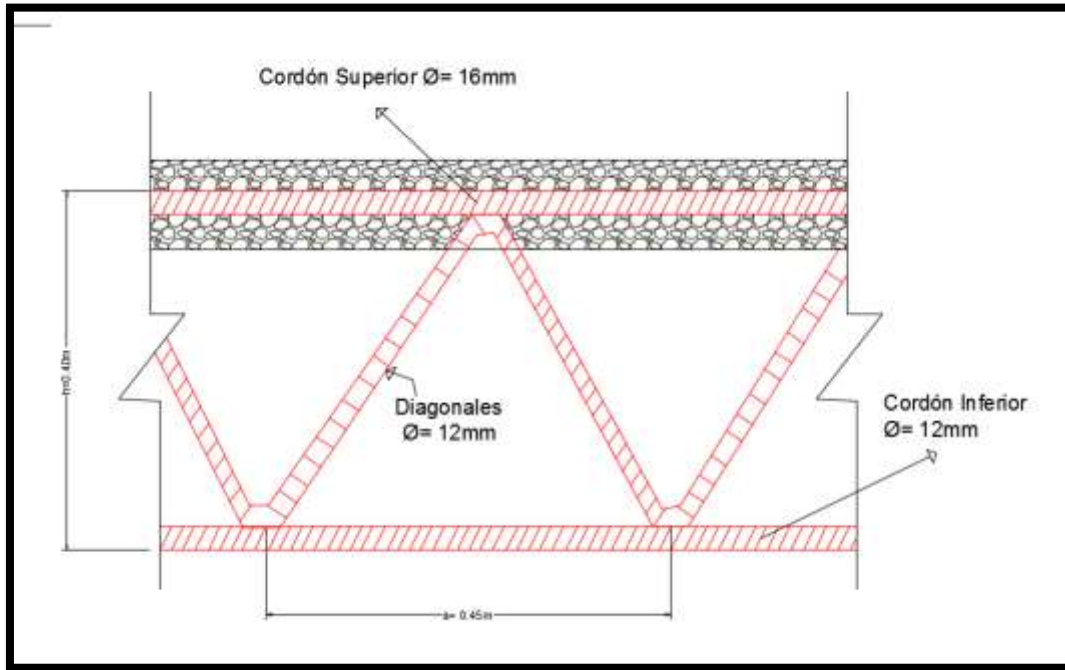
Detalle de una Sección de losa de Cubierta Rectangular.
